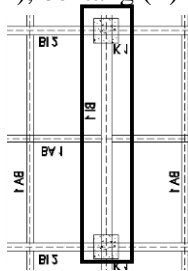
1 Denah Struktur Gedung Hotel Dafam
